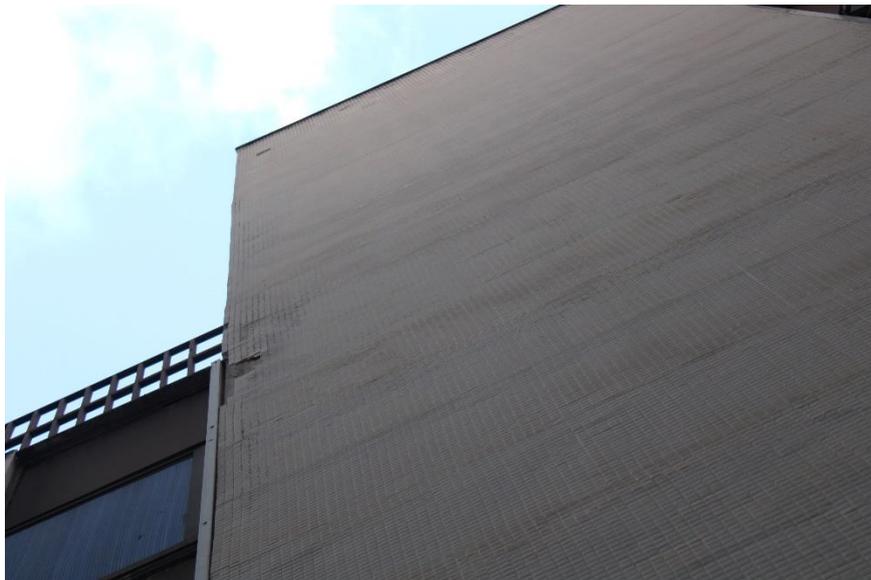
Vista deplacamento do revestimento da fachada – área externa 3º pavimento
